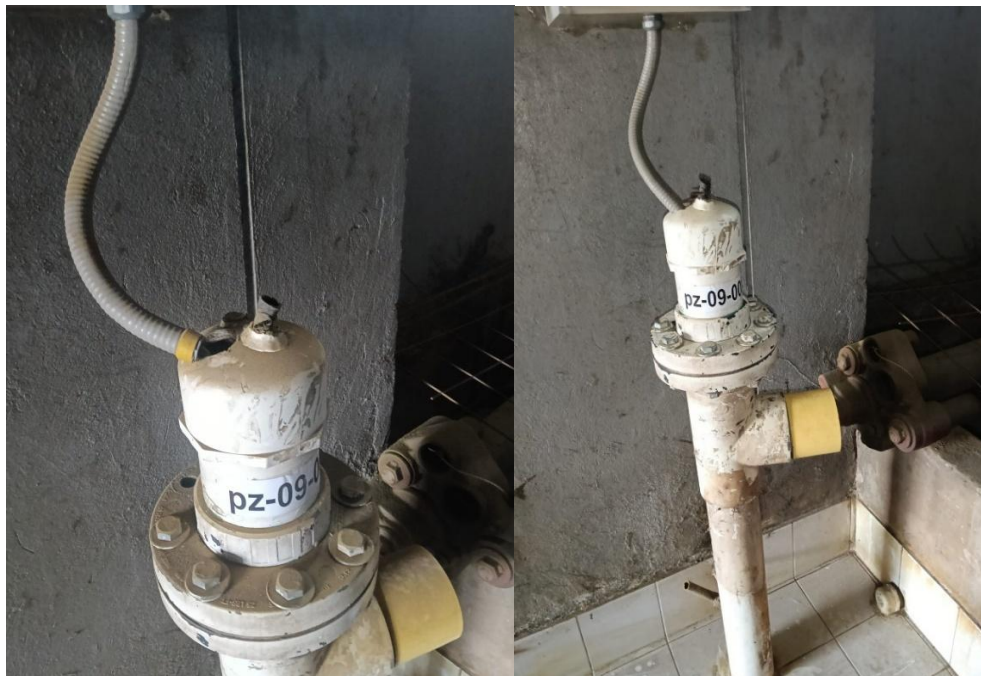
Estado de infraestructura de tubería de acceso al pozo antes y después del MTTO.
